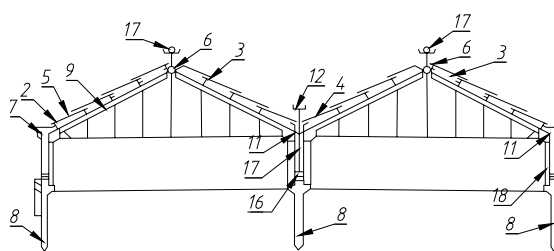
Каркас несущих конструкций многопролетных здания
